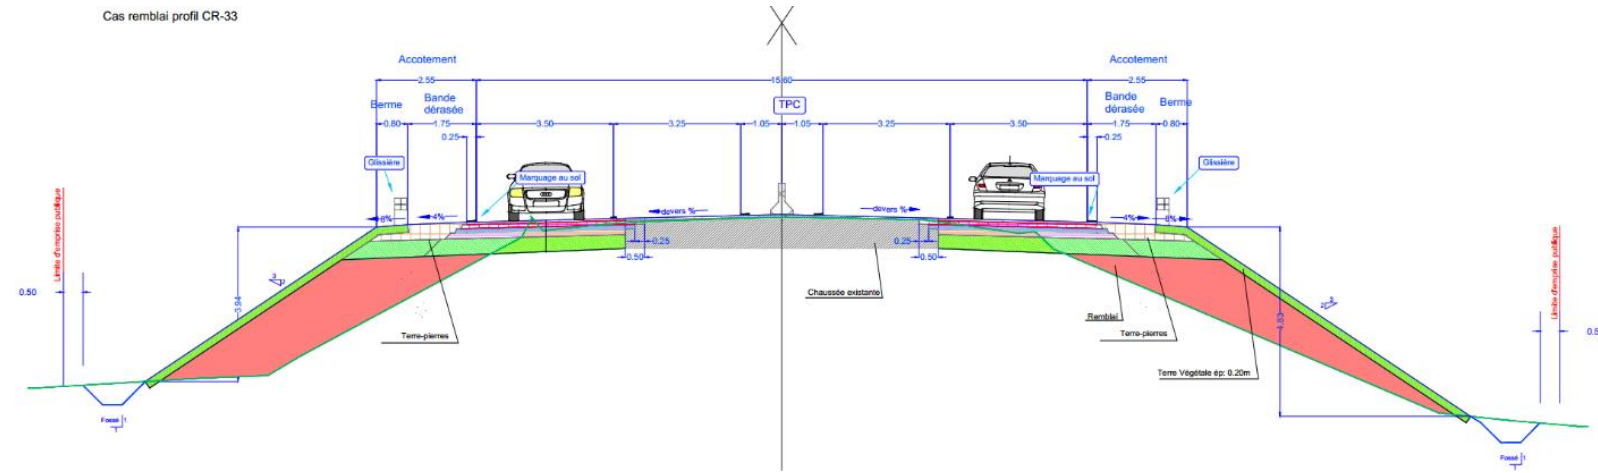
Exemple de profil en travers dans la section en remblai (N°24)
